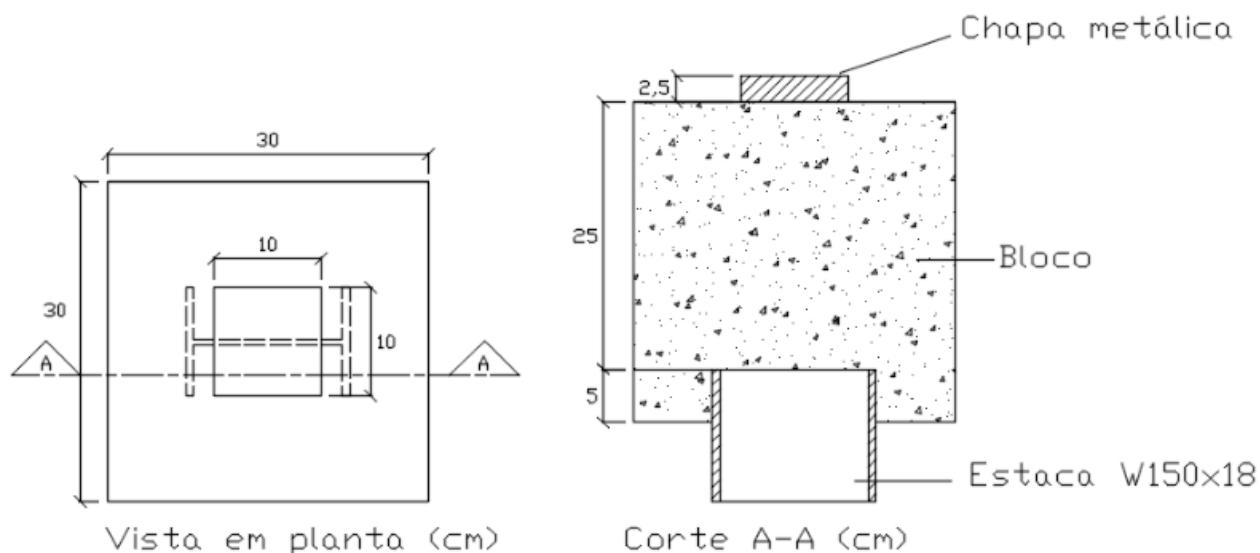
Bloco sobre estaca metálica. Vista em planta e corte, autores (2017), dimensões em cm.
